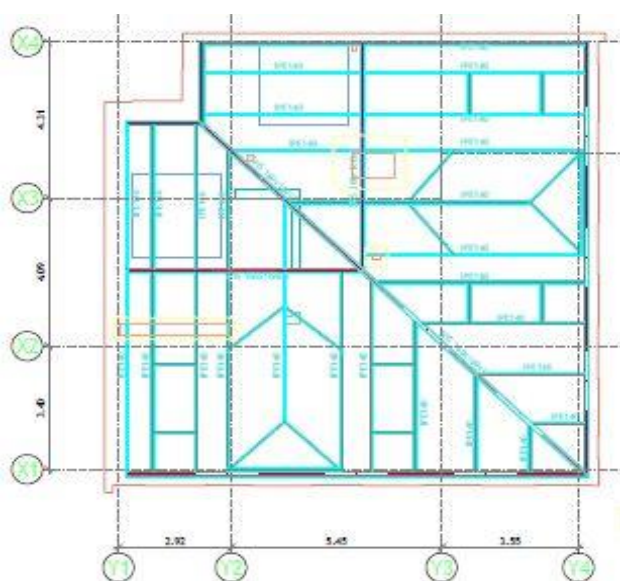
Planta Estrutural Pormenor de Reforço da Cobertura
